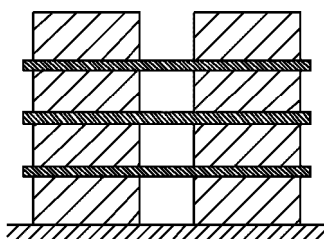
Sistemas estructurales mixtos. Tipo 3 – muros de hormigón o mixtos acoplados por vigas de acero o mixtas
